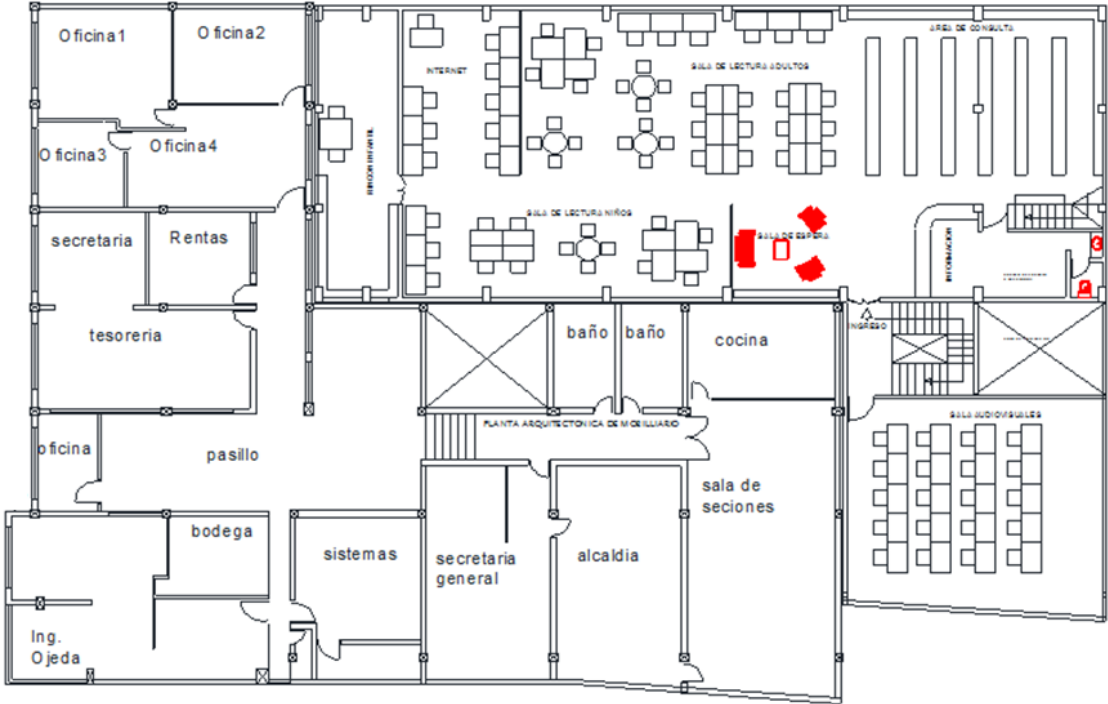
Planos de la Segunda planta y su distribución
